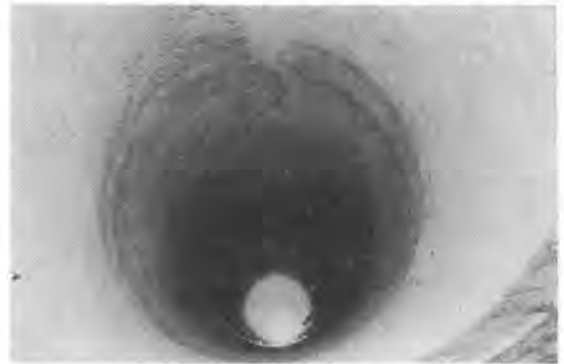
地山掘削孔 (φ2.5 m ホワイトビット)
